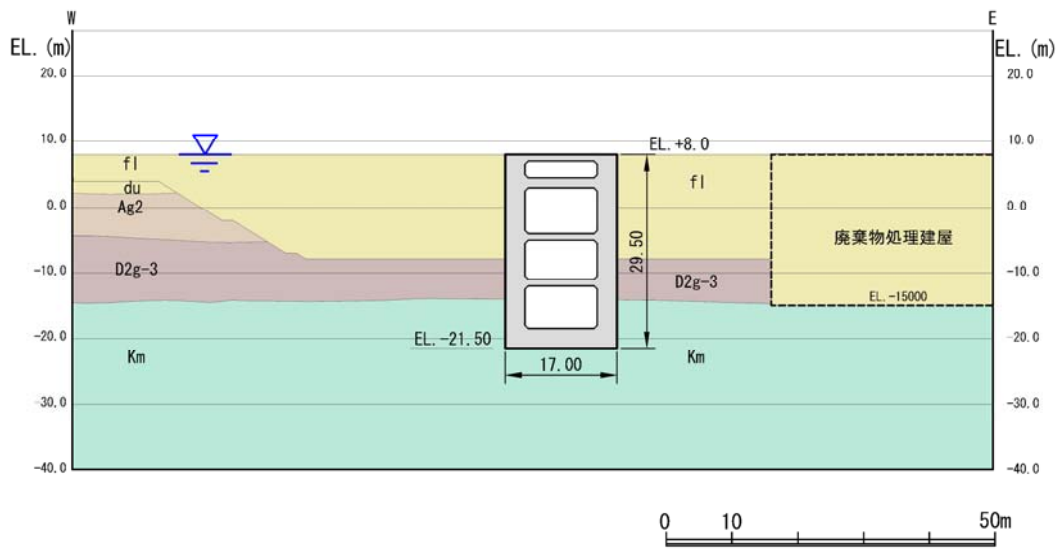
(9) 常設低圧代替注水系ポンプ室評価対象断面図 (東西方向断面)
